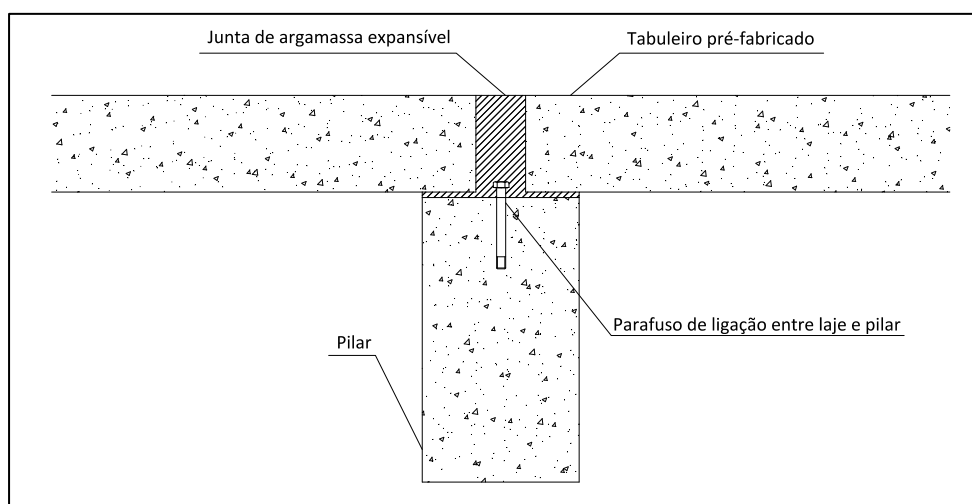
Pormenor da ligação tabuleiro-pilar de bordo
